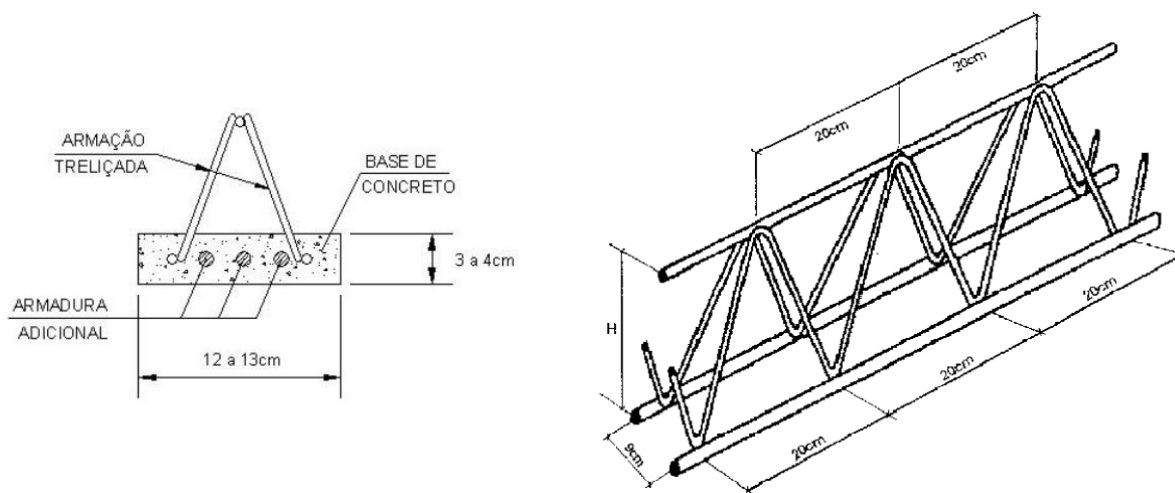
Vigotas treliçadas (MANUAL DE FABRICAÇÃO DAS LAJES PUMA, 2003).
